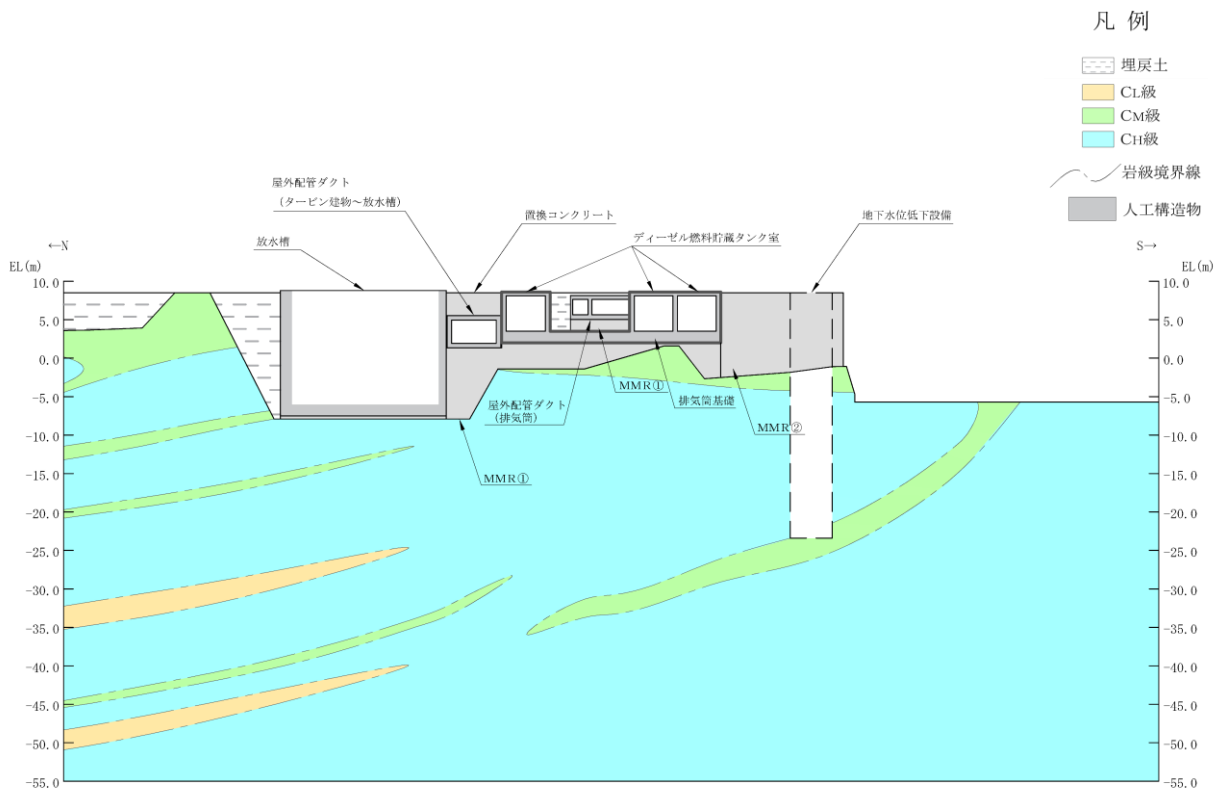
屋外配管ダクト (排気筒) 評価対象断面図 (A-A断面)
